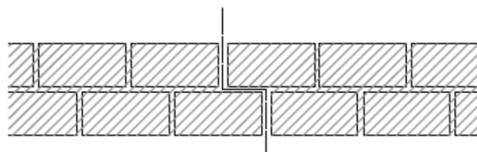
Junta de movimiento con solape. Esquema en planta
